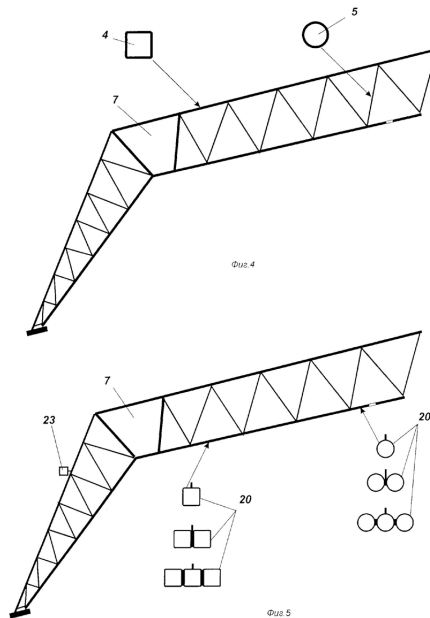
Фиг.4 – варианты сечений элементов верхнего пояса фермы и раскосов; фиг.5 – варианты сечений элементов нижнего пояса [4], где: 4 – верхний пояс секции; 5 – раскосы; 7 - несущие опорные узлы; 20 – подвижные элементы нижнего пояса; 23 – лебёдка.
